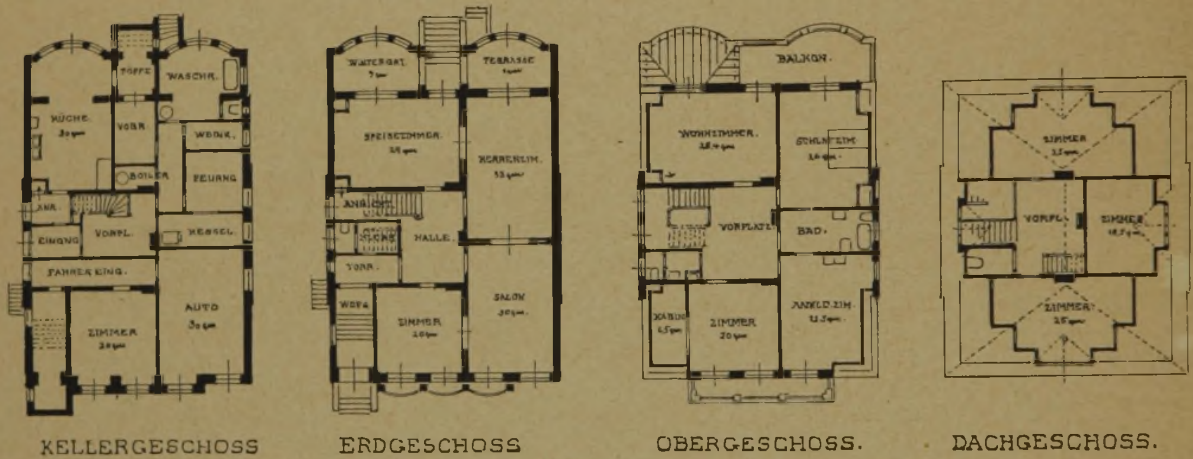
Grundrisse zum Haus Heilwigstraße 134.
